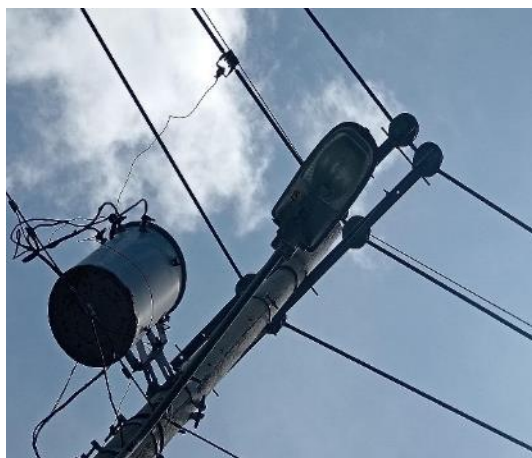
Iluminación en obras del Campo y Planta Geotérmica
